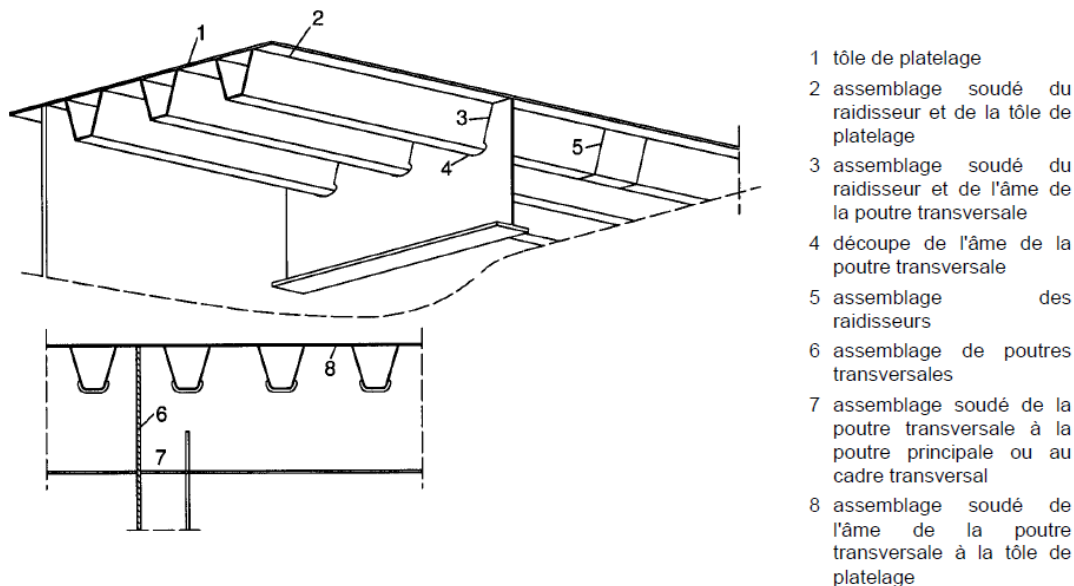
Dispositions constructives des dalles orthotropes [10].
